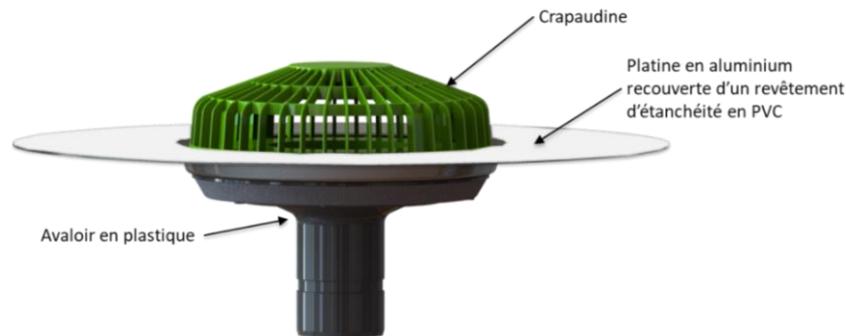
Coupe sur la naissance Vacurain associée à un revêtement d'étanchéité PVC-P
